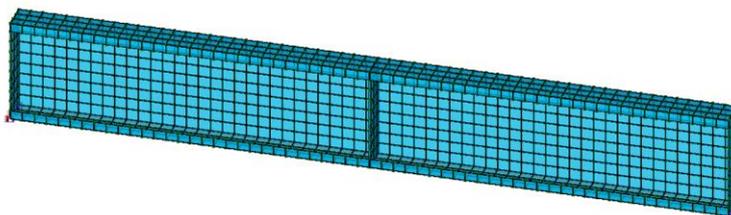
Расчетная схема двухпролетной С-образной балки в ПК SCAD
